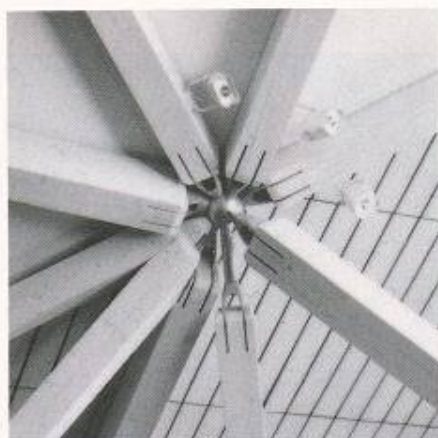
Hochbelasteter Knoten mit 9 angeschlossenen Stäben (Detail)
